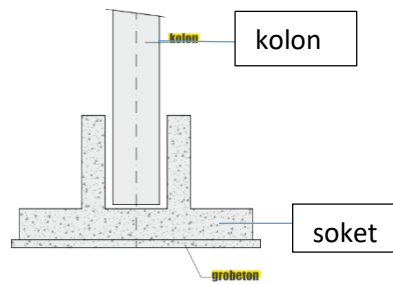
Betonarme prefabrik yapı (Url-19)
